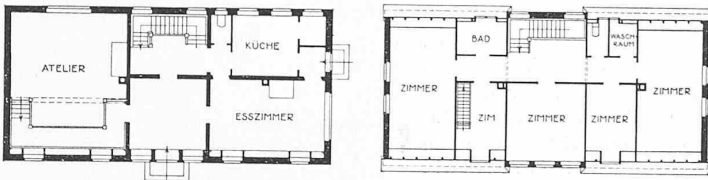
u. 5. Grundrisse, Masstab 1 : 400. — Arch. Hermann Haas, München.
